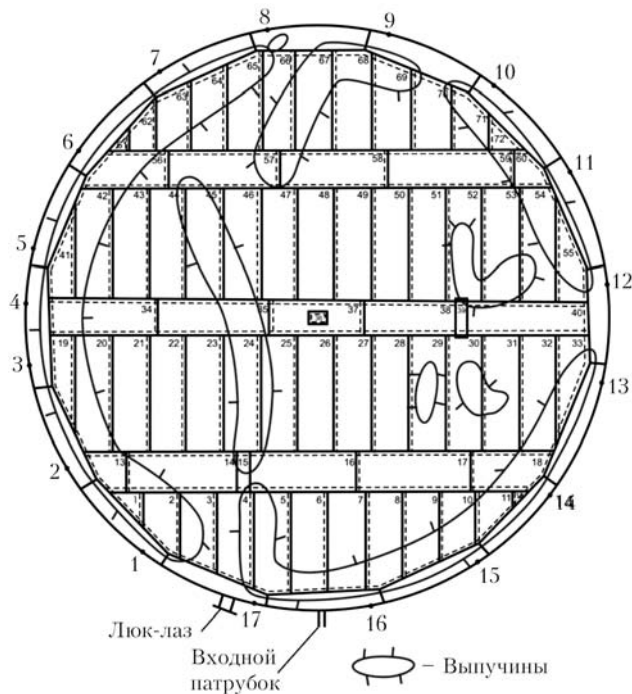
Схема днища внутреннего резервуара: 1–17 — вертикальные сварные соединения 1-го пояса стенки
